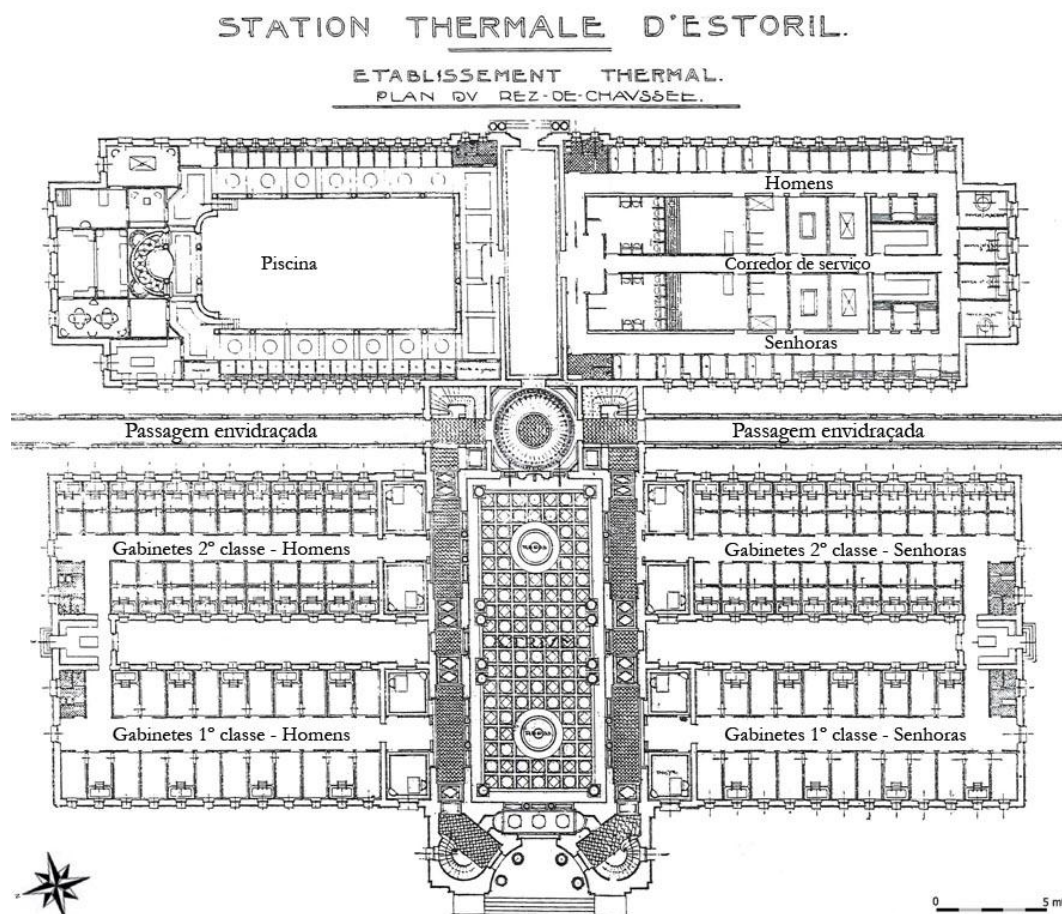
Planta do piso térreo do Estabelecimento Thermal (1914).
